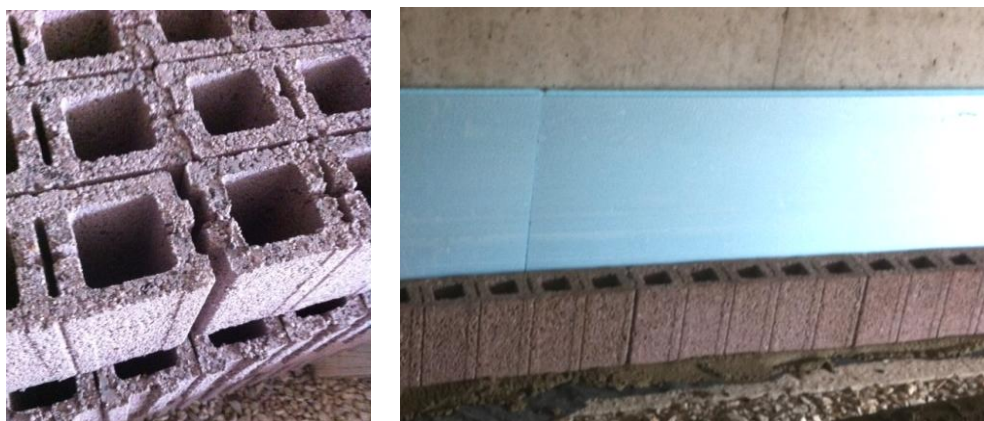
Elementos de alvenaria com juntas verticais de encaixe.
